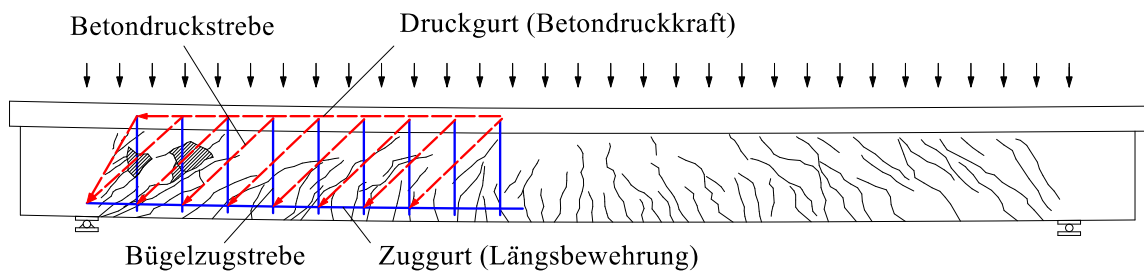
Idealisiertes Fachwerk mit Rissbild aus Leonhardt und Walther (1962)
